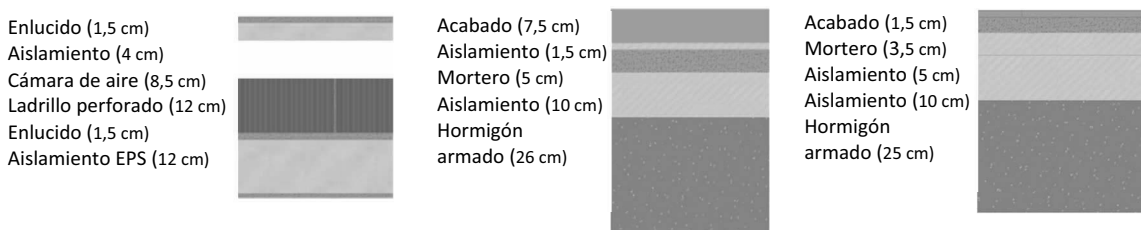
Sección muro tipo, planta sótano y cubierta, respectivamente
